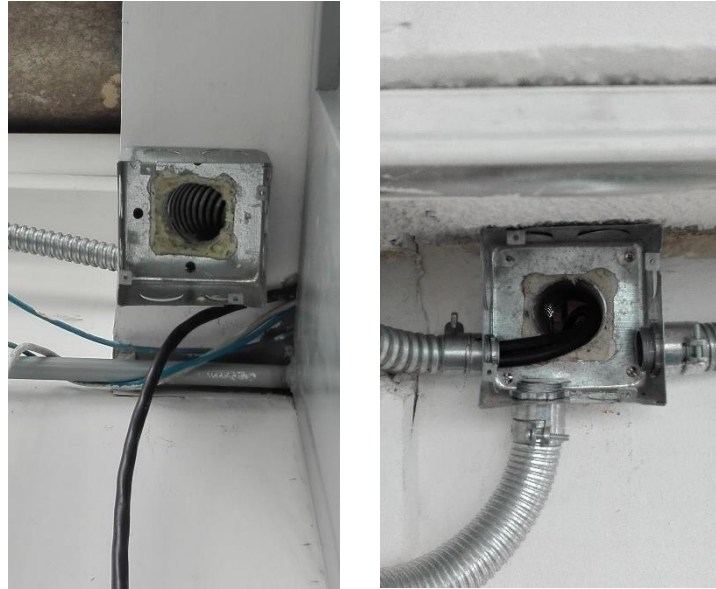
Instalación de tubería y manguera BX planta alta 2.
